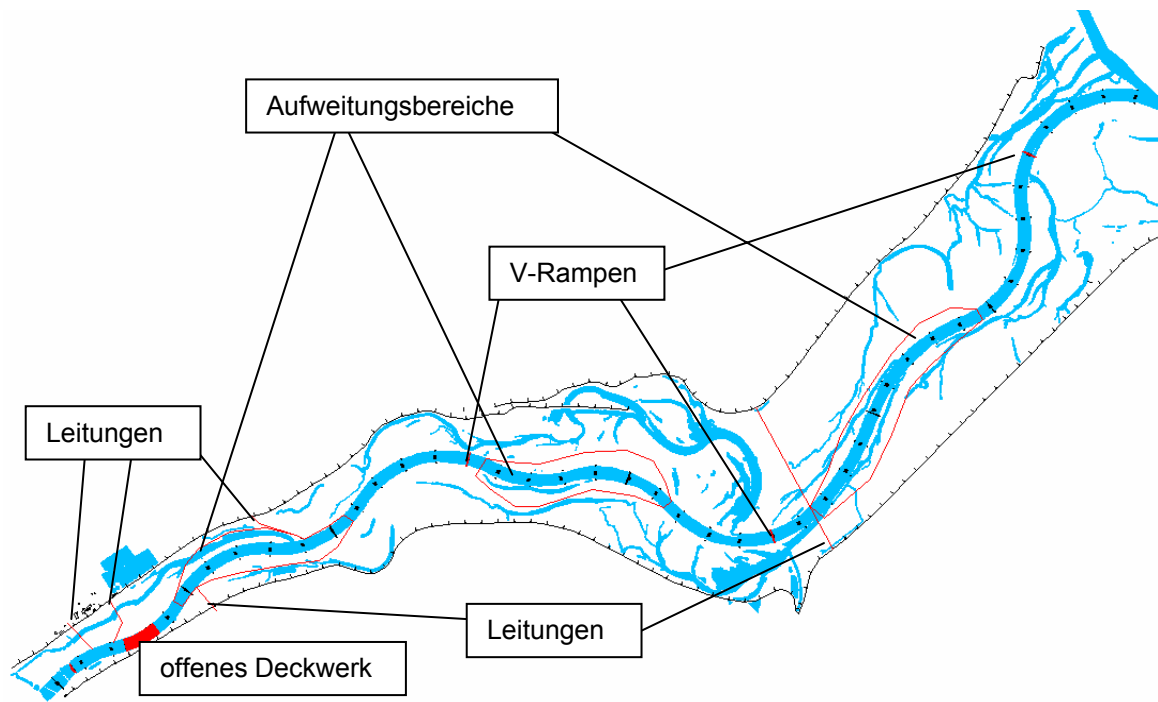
Übersicht; Leitungen, Aufweitungsbereiche, V-Rampenstandorte, Bereich des offenes Deckwerk
